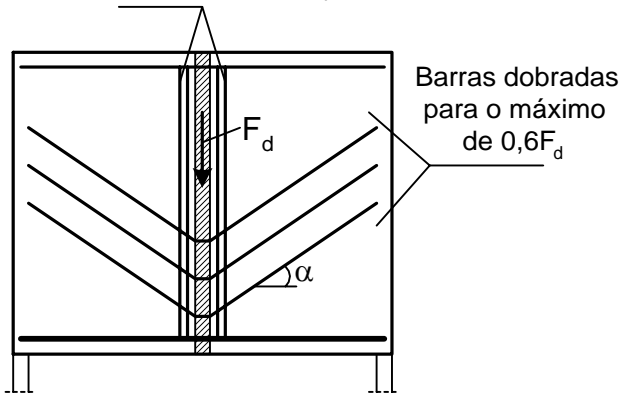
Armadura de suspensão para cargas indiretas concentradas
